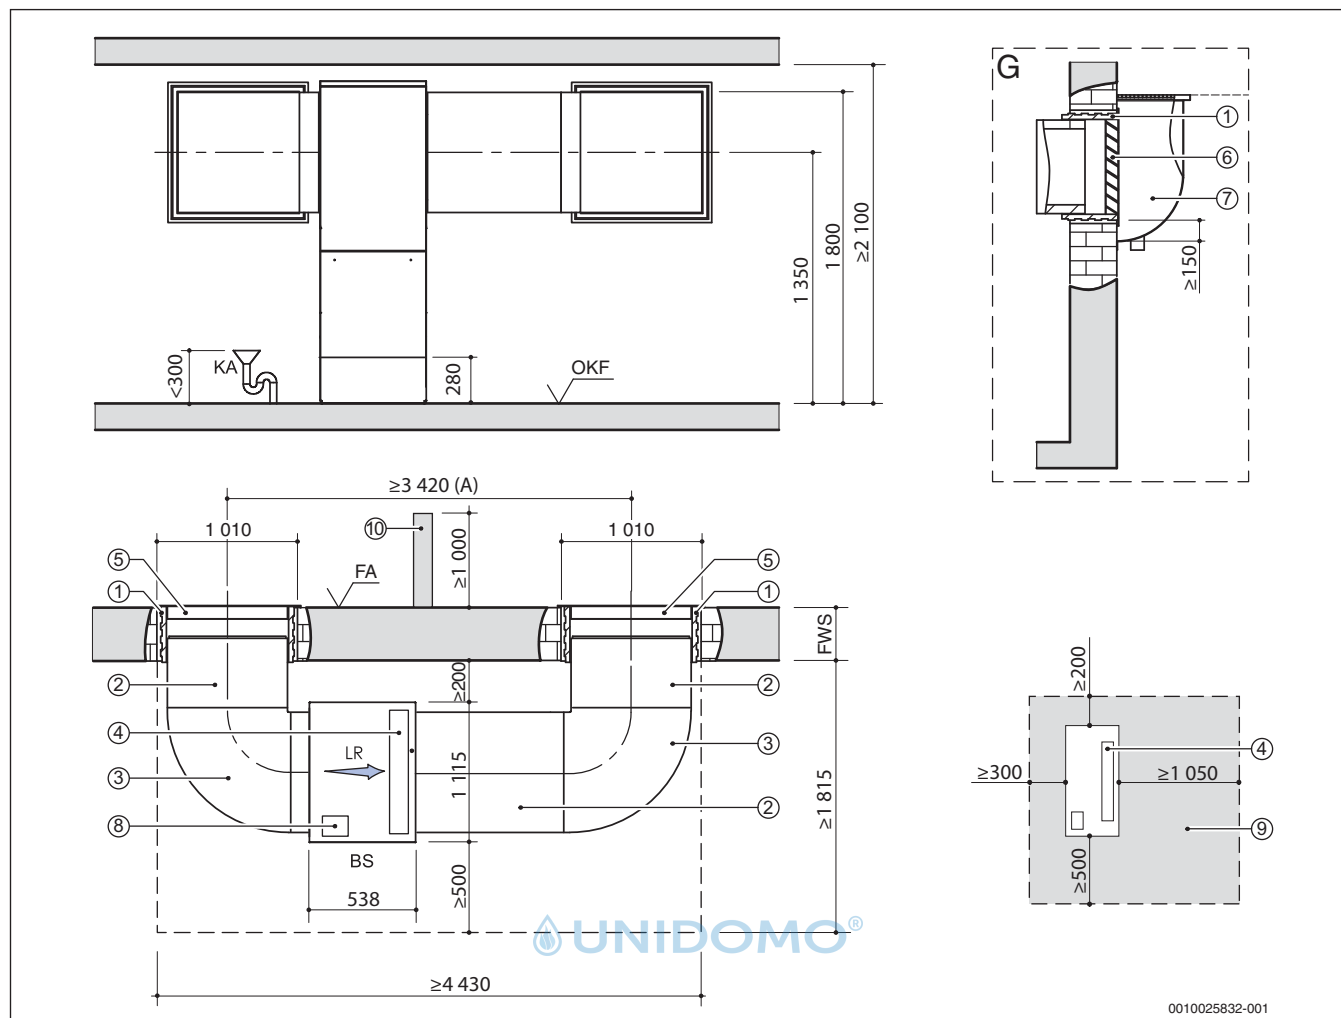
Aufstellplan (beispielhaft) für WLW196i-11/14 IR mit Luftkanalsystem 900 (alle Maße in mm)
